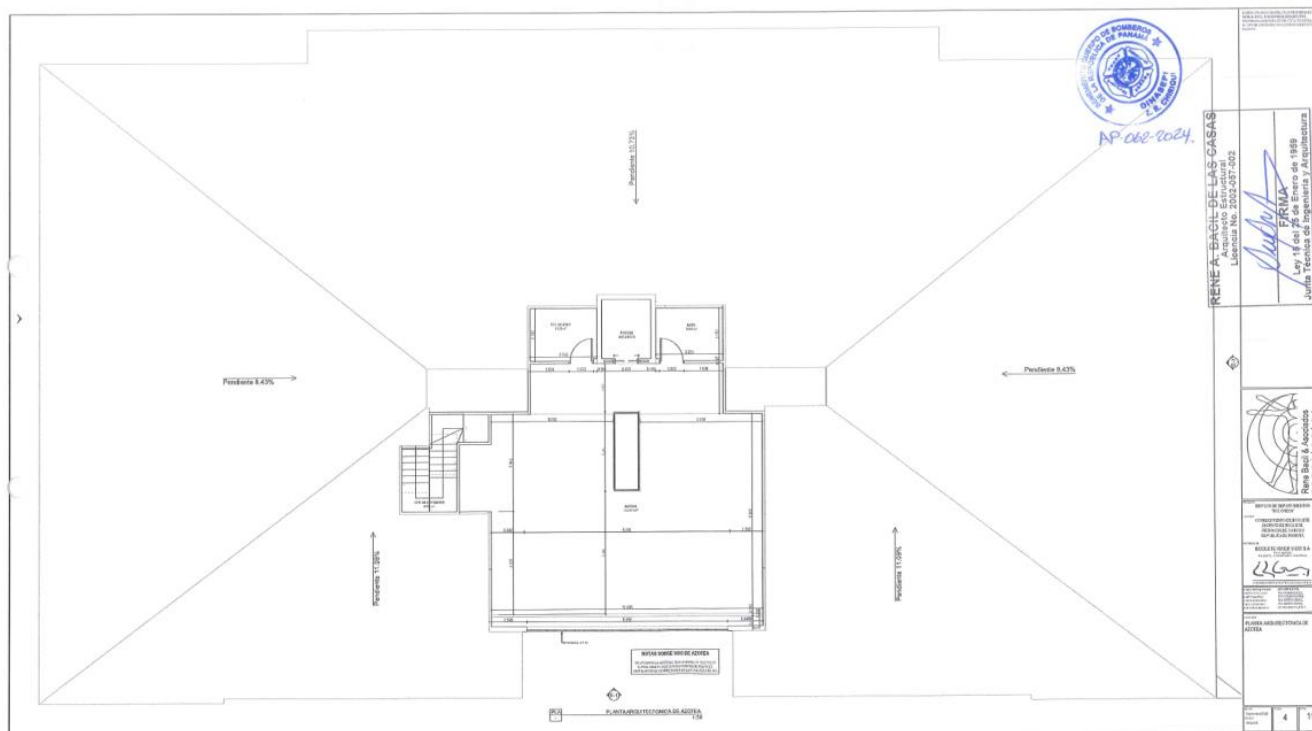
PLANTA AZOTEA – NIVEL 4 “BOQUETE RIVER VIEW”
